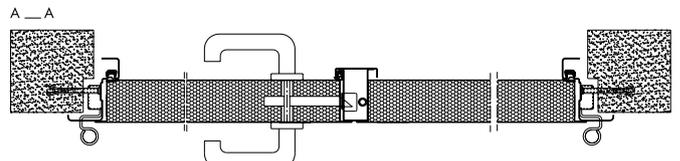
Horizontalschnitt Stahlaußentüren ECO mit Eckzarge in Höhe des Schlosses.
